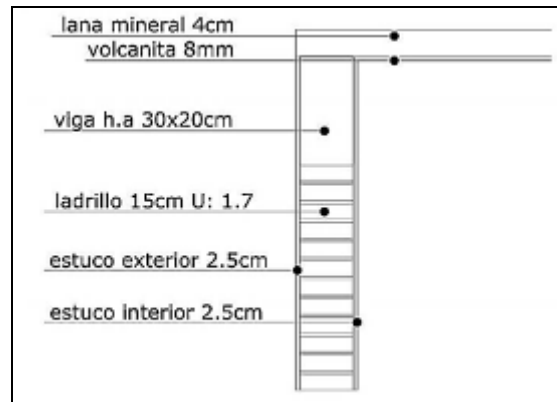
FACHADA DE LA VIVIENDA PARA EL ANÁLISIS
